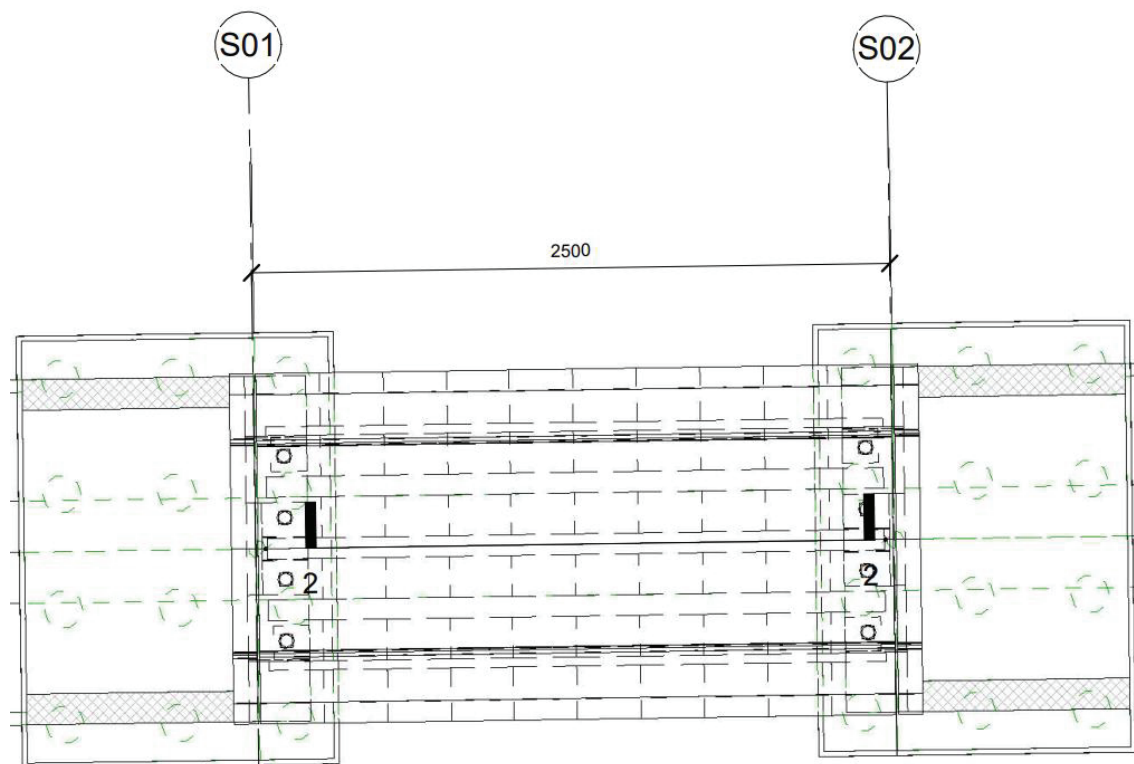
Pianta delle fondazioni delle pile e delle spalle
